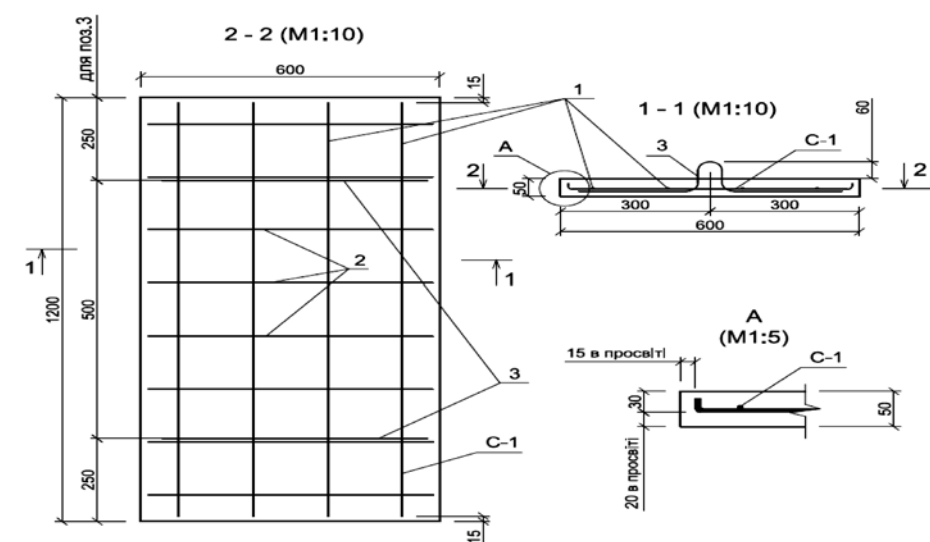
Конструкція плити опалубки ПО–1 (ПО–2)
